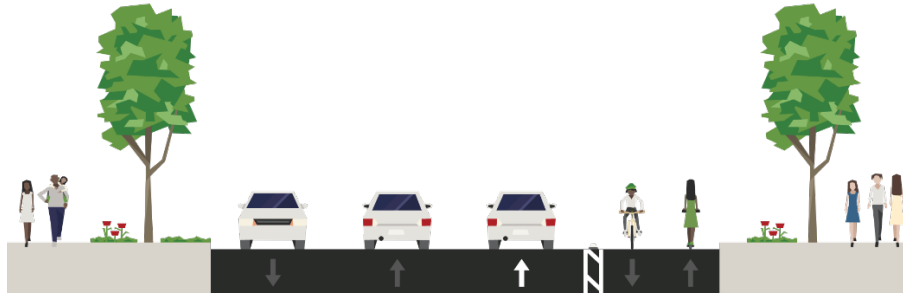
Carril bici segregado en calzada con tachos como elemento de resguardo. Fuente: Elaboración propia Streetmix.
